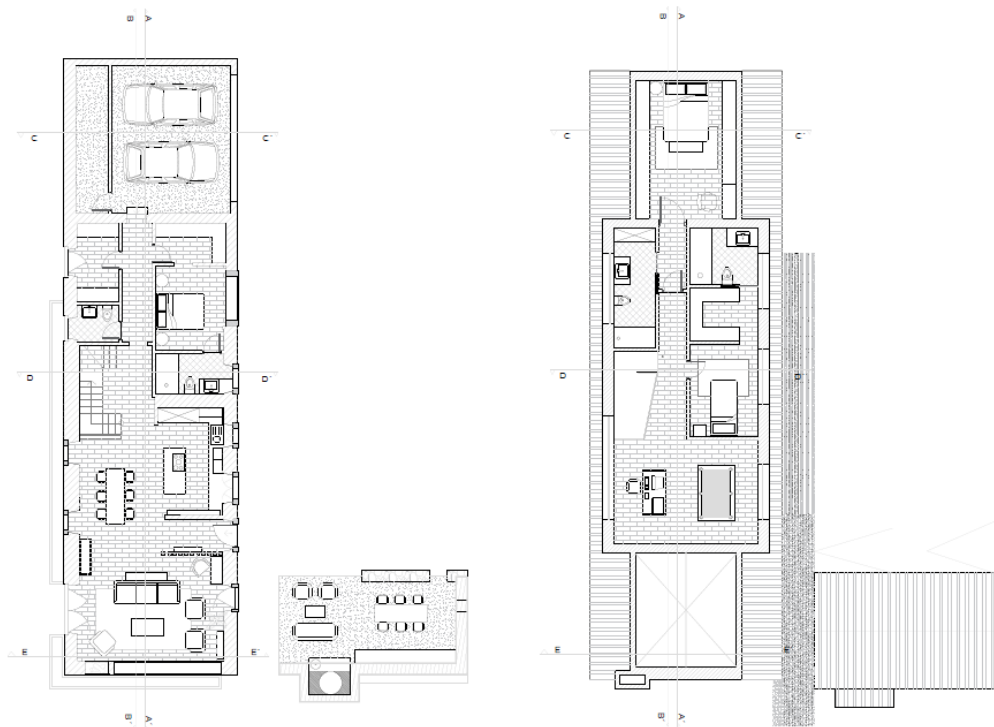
Planta de Apresentação Fonte: Jacinta Vaz, 2023
